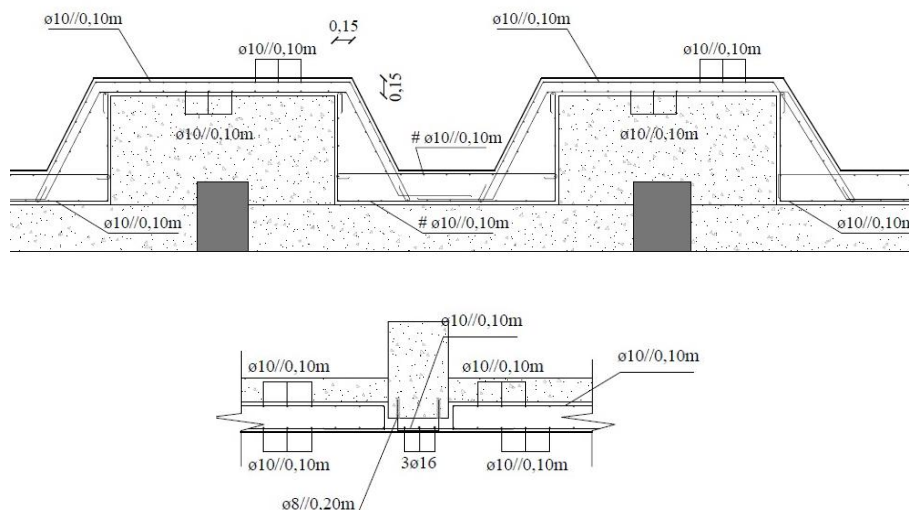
Detalhe da armadura da parede orientada a Norte: a) envoltória das sapatas existentes; b) ligação da parede aos pilares existentes
